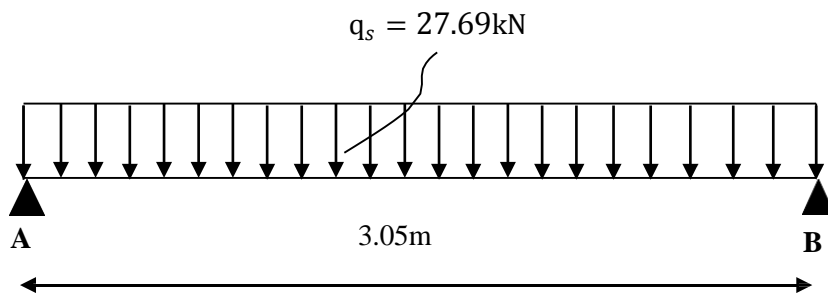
Schéma statique de la poutre palière a l'ELS
